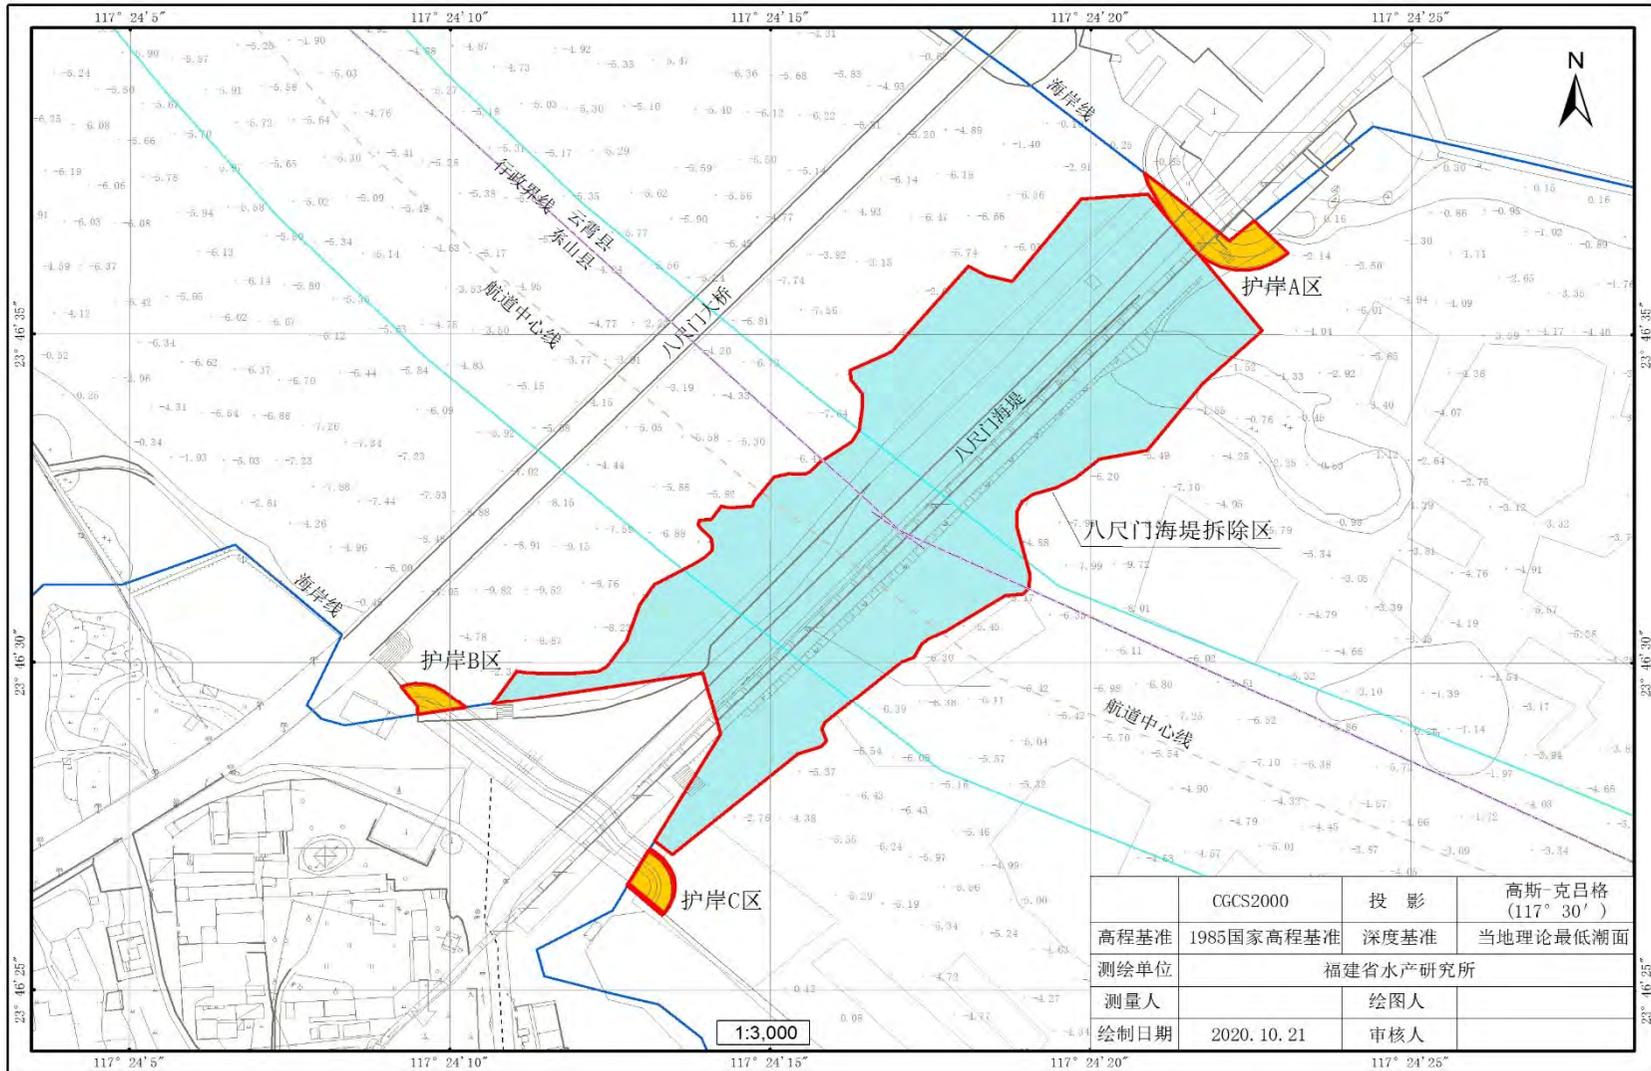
东山县海堤贯通工程-海堤拆除工程宗海平面布置图
